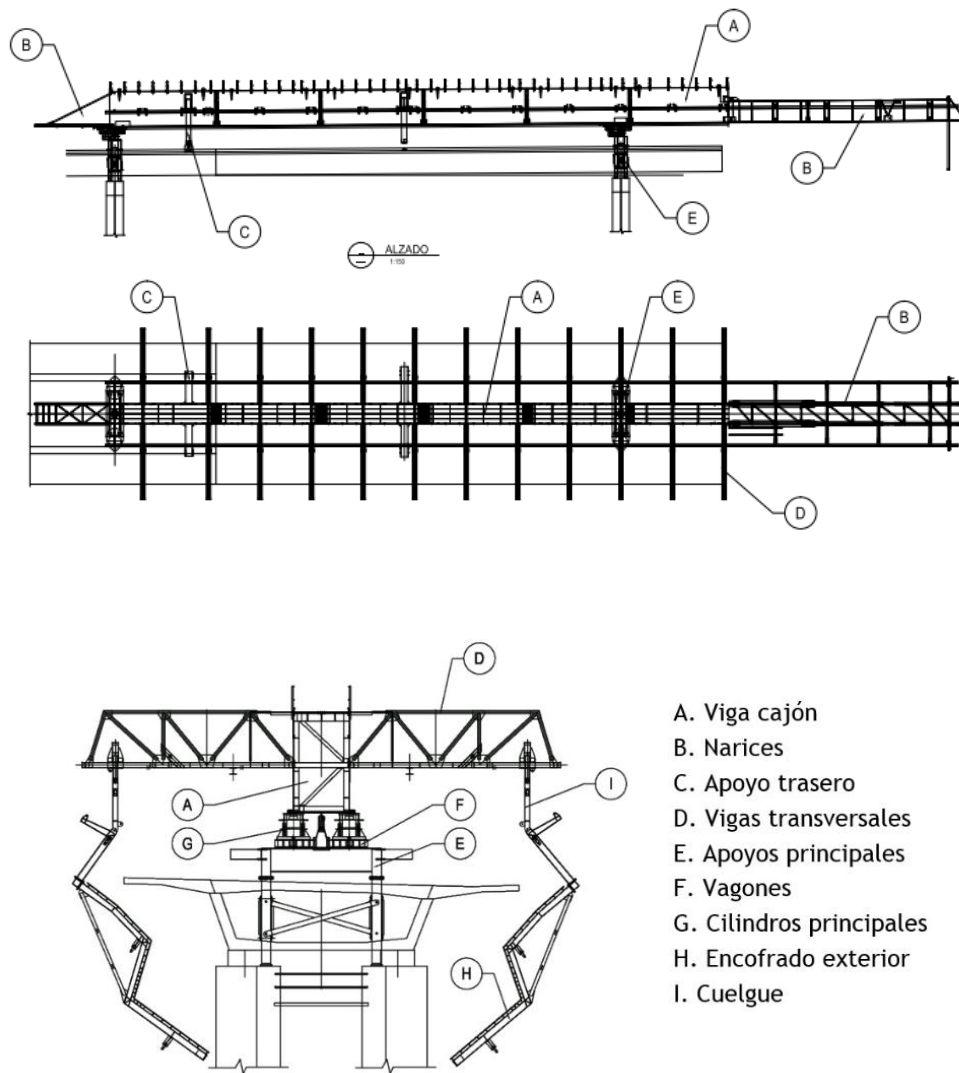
Planos cimbra autoportante sobre tablero. Fuente [19]
